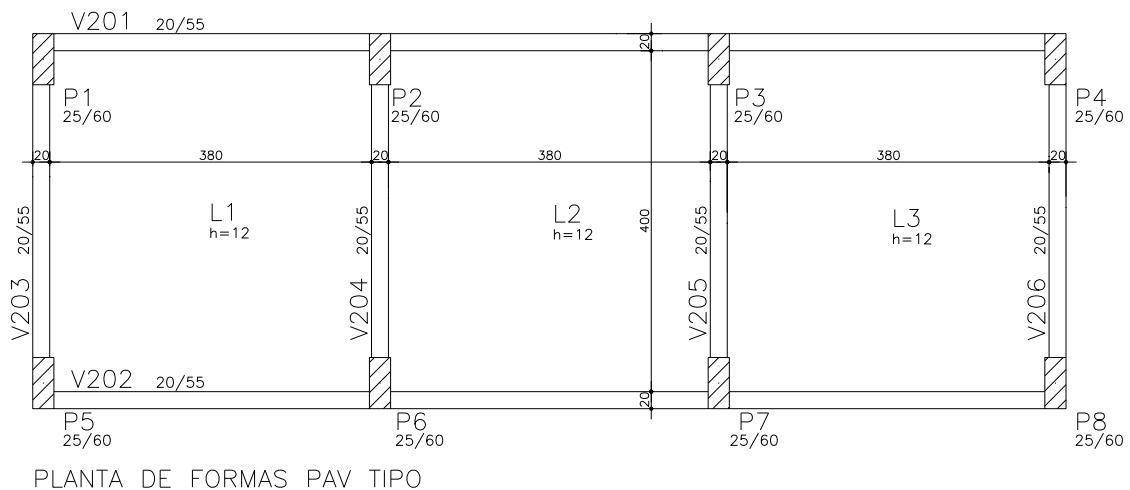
Planta de formas do pavimento tipo: T1 -4P2V2
